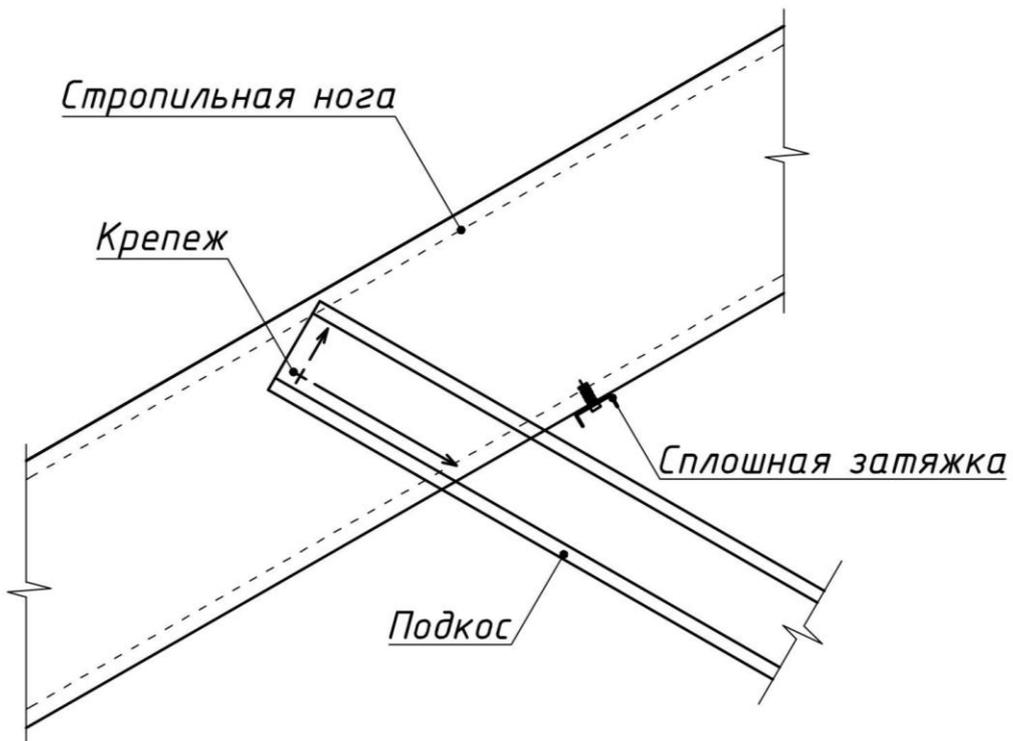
Узел К 10. Крепление подкоса к стропильной ноге
